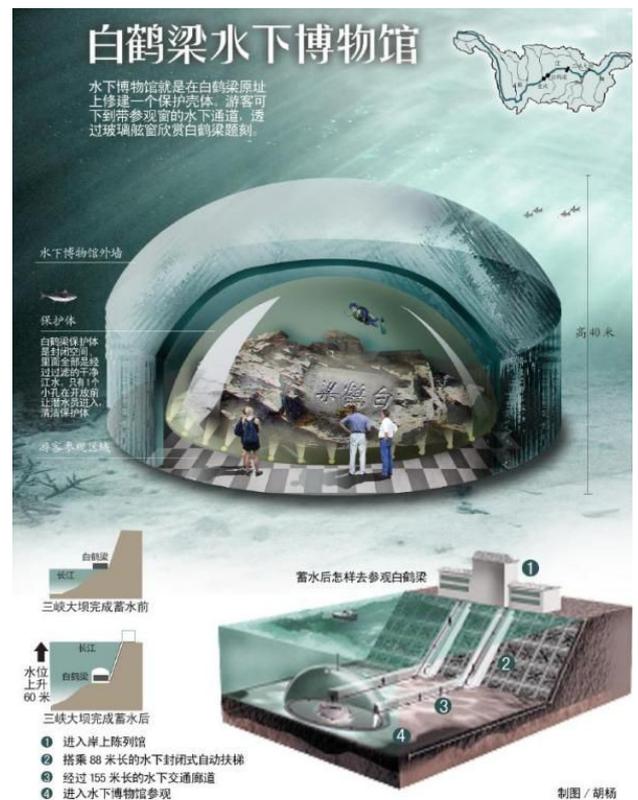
El Museo subacuático de Baiheliang se inauguró en 2009 con las imágenes detalladas de esta construcción y su plano de 3D
